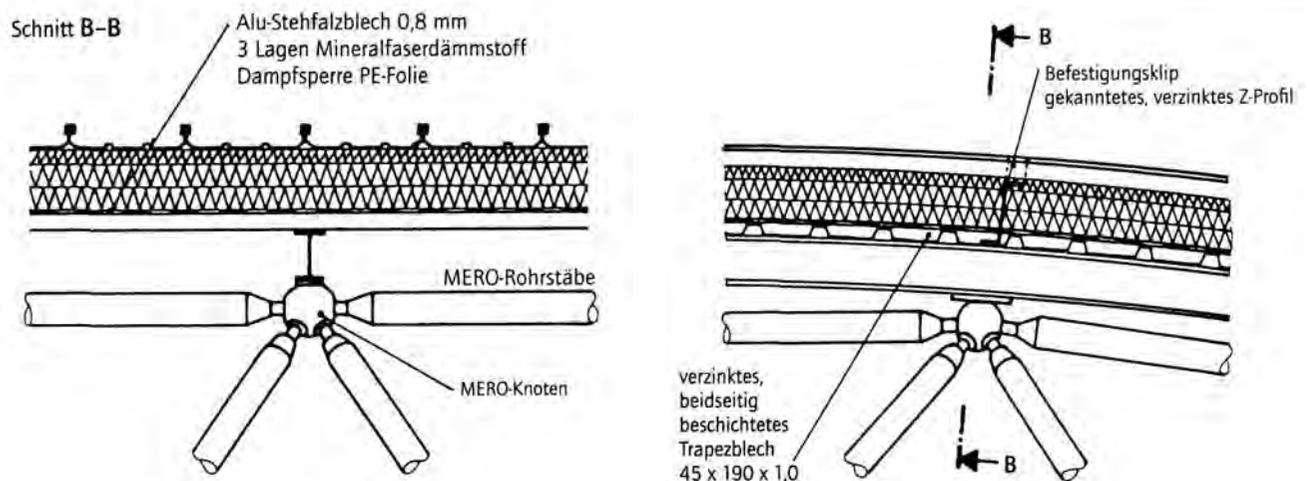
Halle Münsterland, Münster, Detail des über die alte Halle gespannten Dachaufbaus, aus /124/
